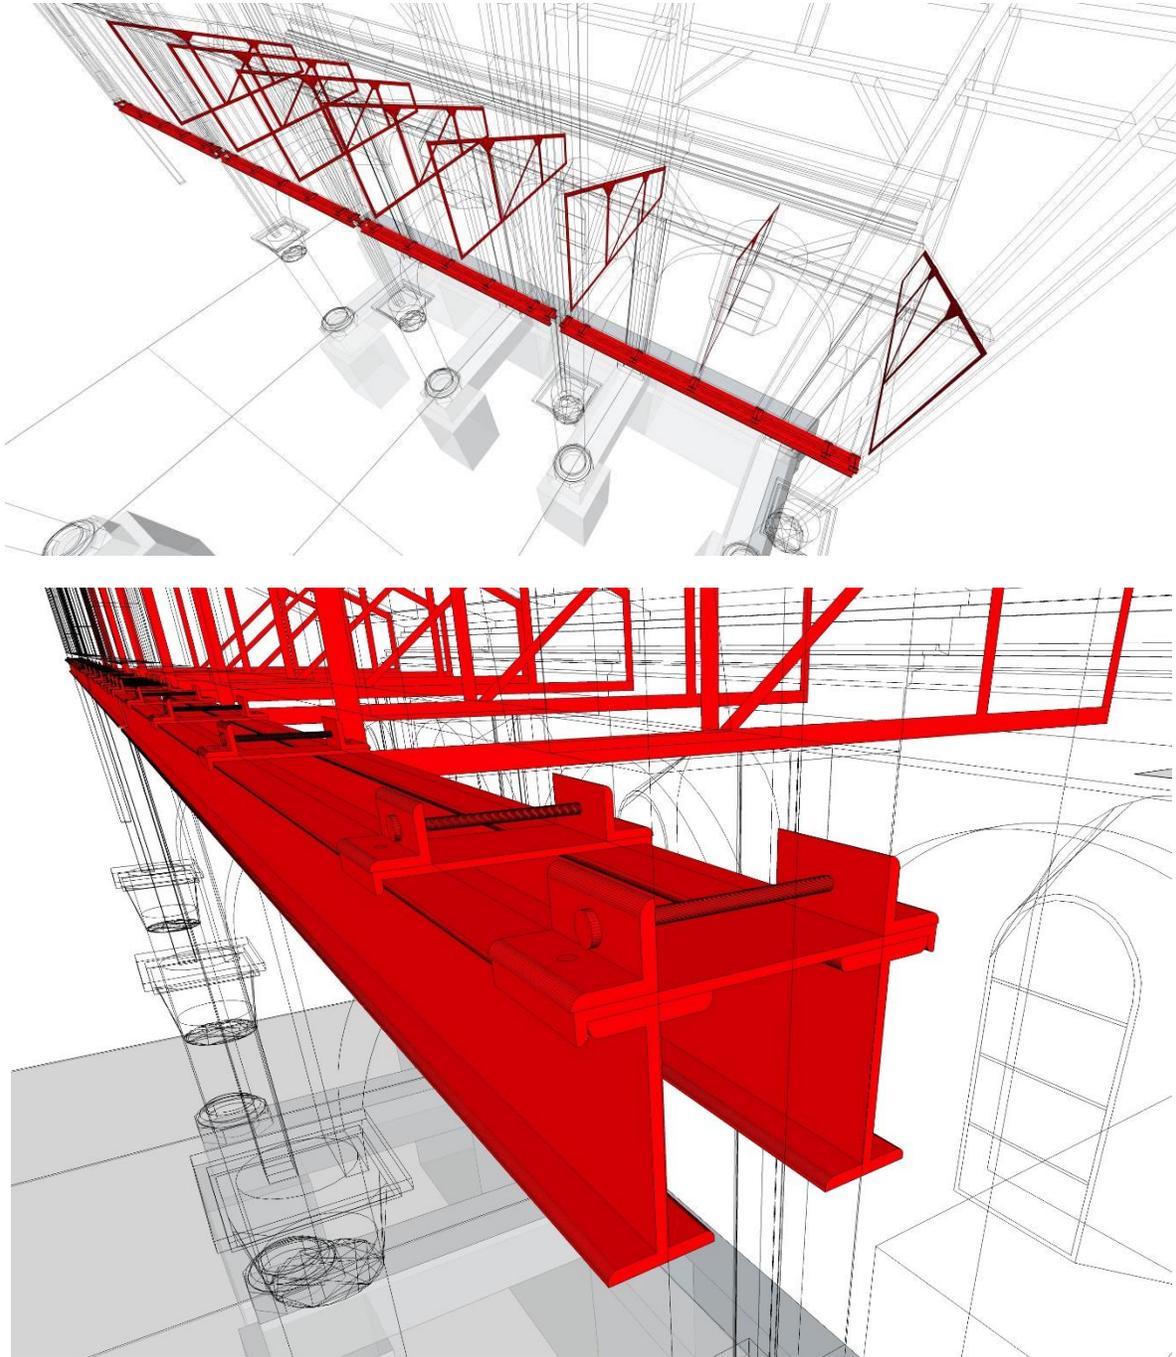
Esquema detalle de vigas soleras de estructuras de metal y conectores. Elab. Propia.
